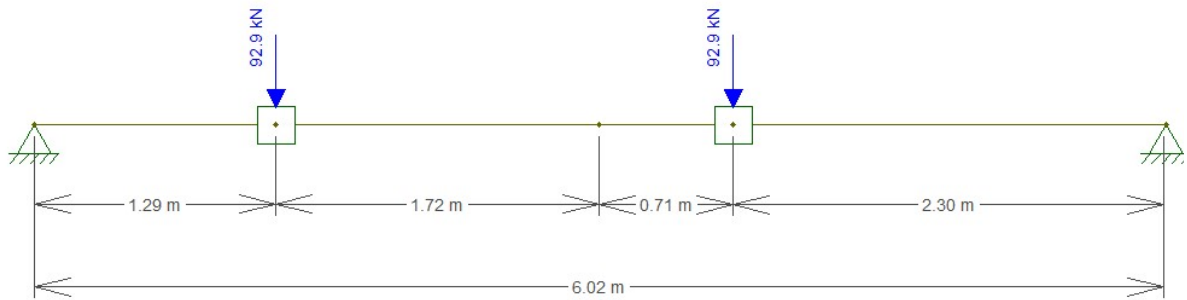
Viga exemplo 2 com perfil W 360X32,9
